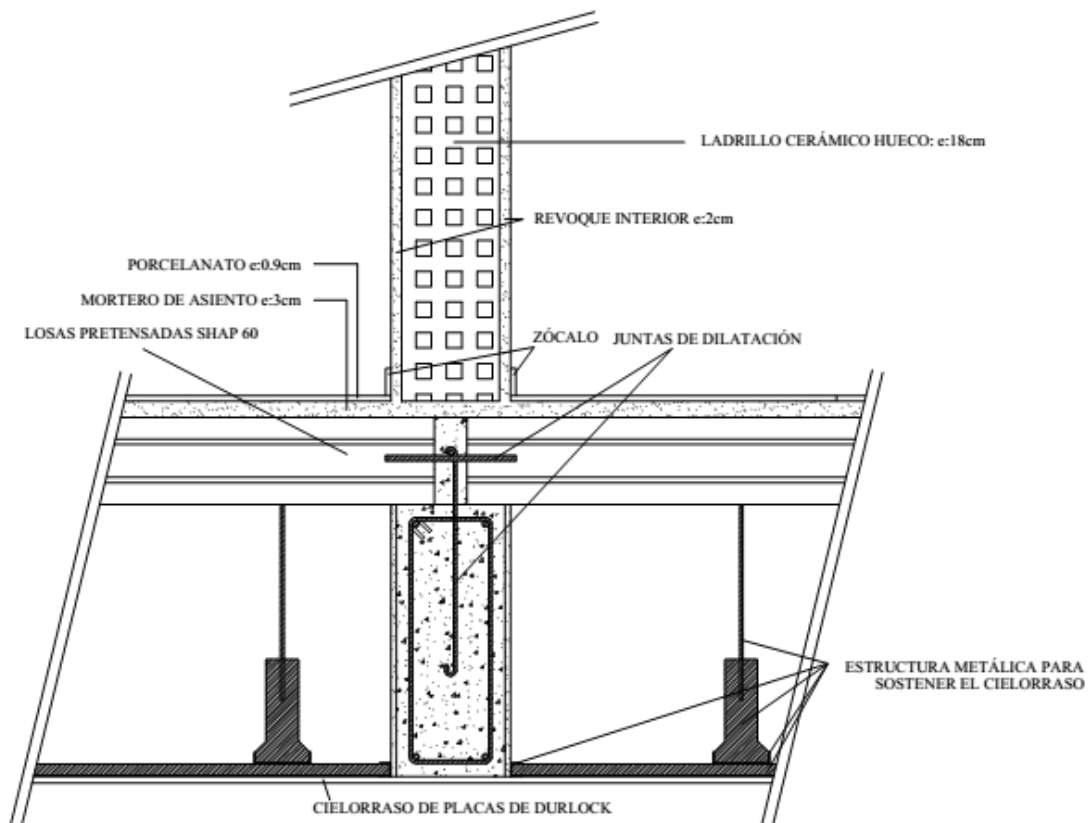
Esquema de entrepiso y encuentro con pared interior
